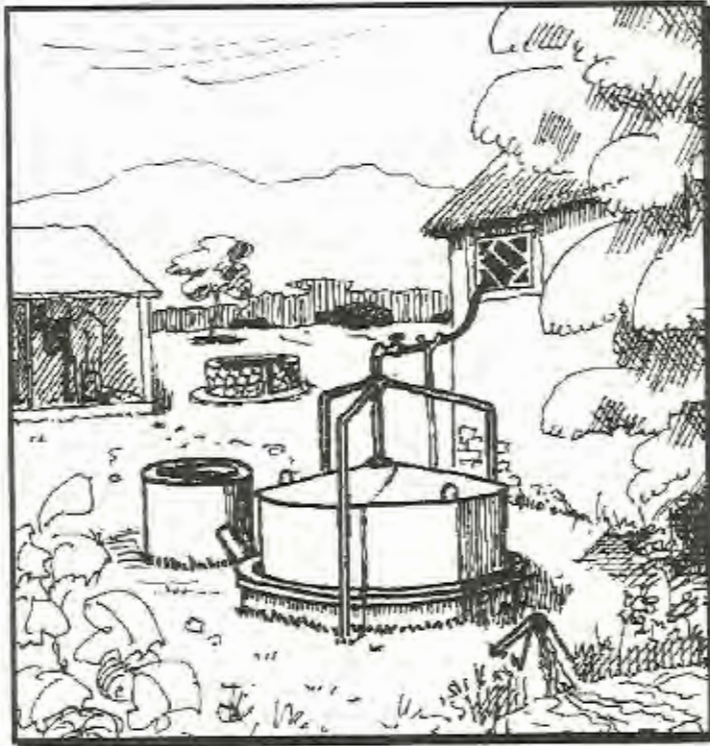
LA PLANTA DE BIOGAS EN LA FINCA. FUENTE:
